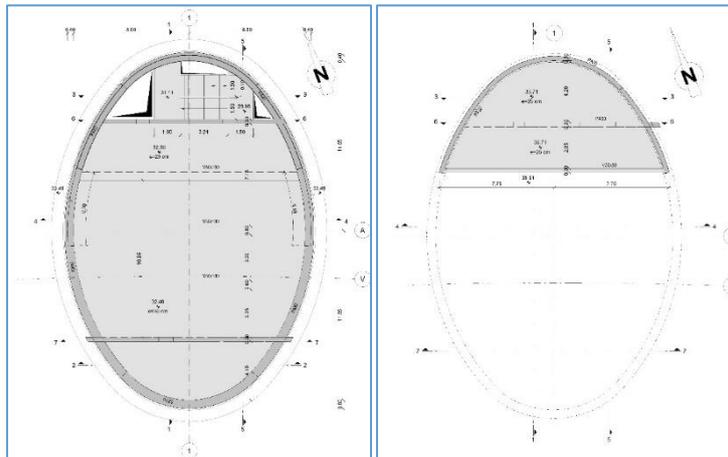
Plantas da cobertura da estrutura definitiva do poço.
